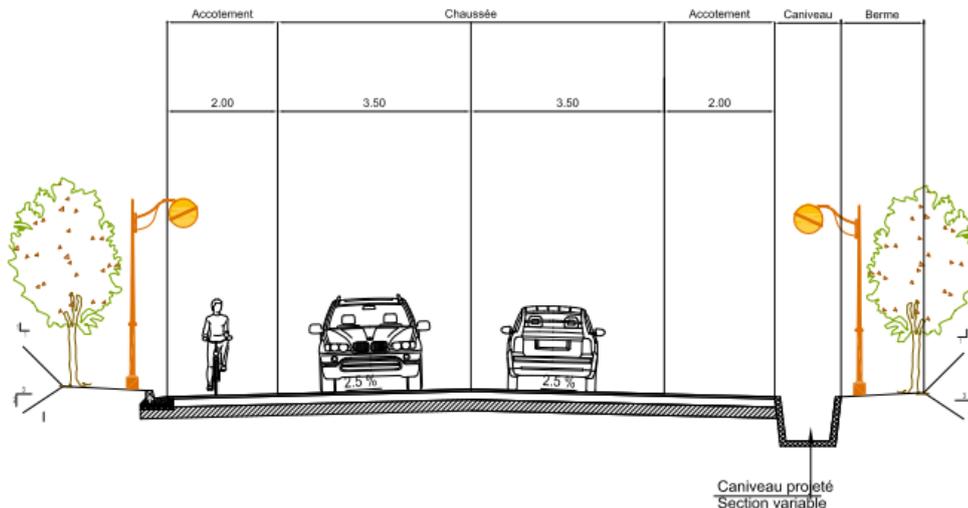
Proposition d'aménagement de la traversée des agglomérations (variante 3)
